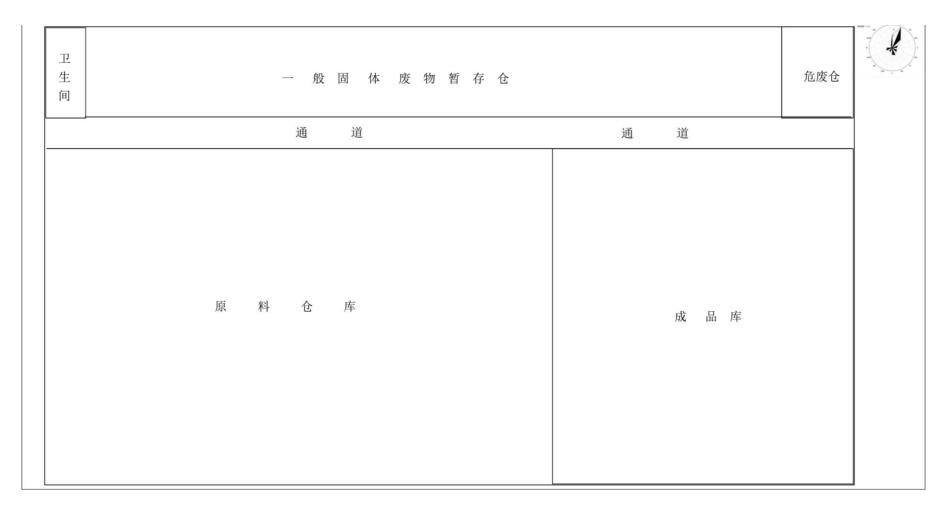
本项目 3#厂房一层平面布置图 (二层为办公区域)
